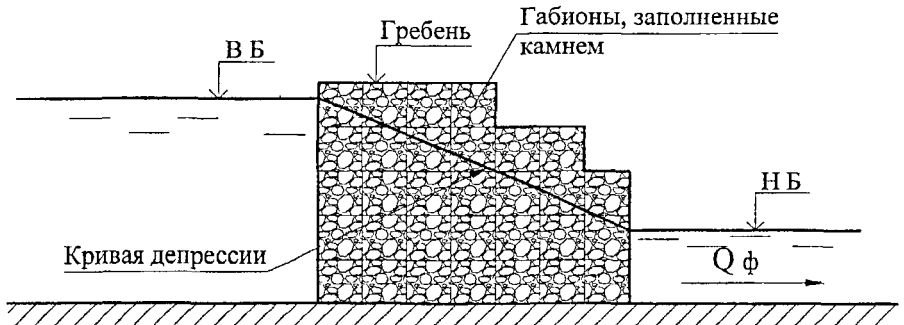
Фильтрующая плотина из габионной кладки (поперечный разрез)
